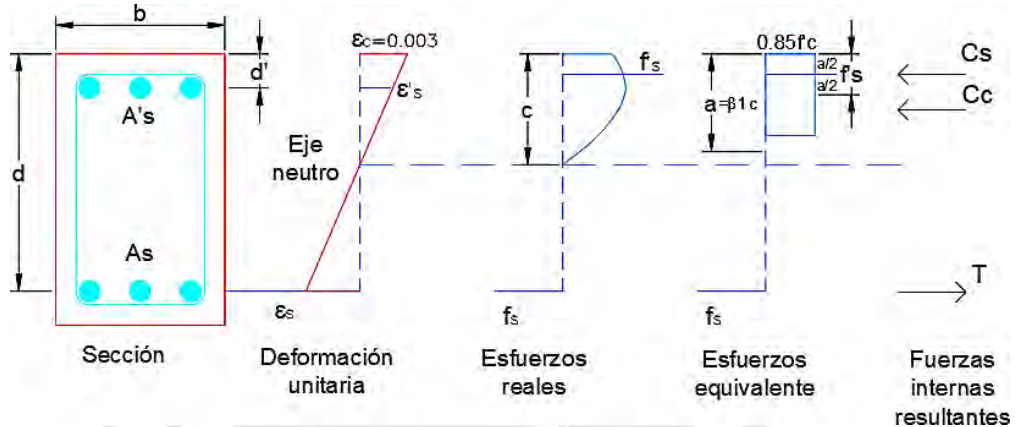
Sección de concreto doblemente reforzada cuando se alcanza la resistencia a flexión.
